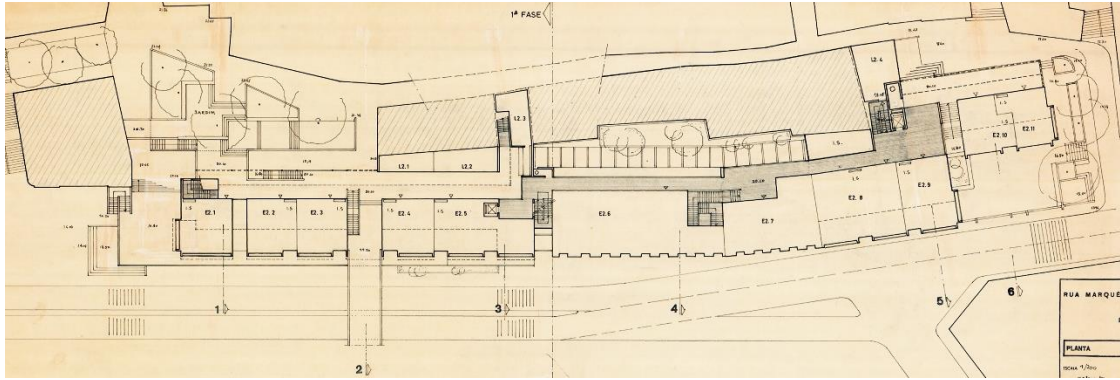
Planta do Piso 2, Estudo Prévio para a Rua do Marquês de Alegrete - EPUL, 30 de abril de 1973.
